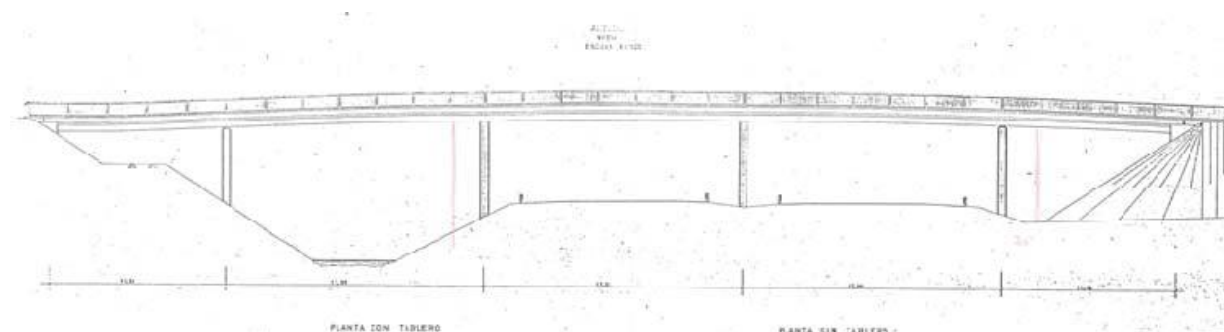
Alzado del puente, se indica el desplazamiento de las pilas P2 y P4. (Mari Bernat, Bairan Garcia, & Moreno, 2011)
